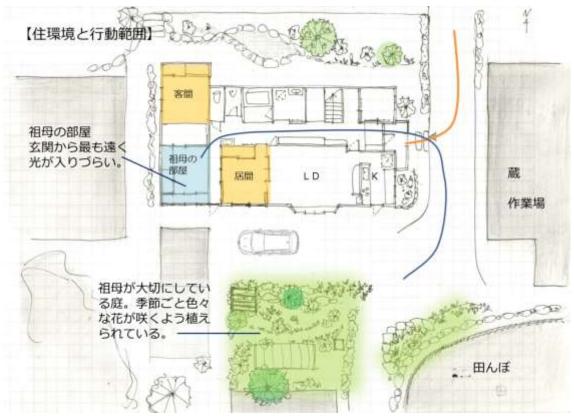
現在の祖母の住む家の様子(一階平面図および配置図)
